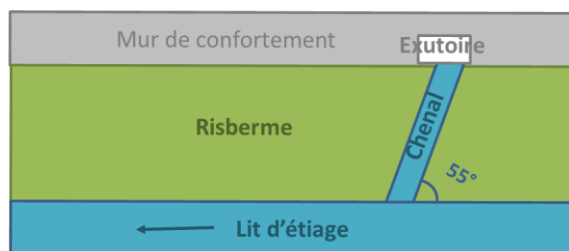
Aménagement de la risberme au droit des exutoires pluviaux en pied de mur
